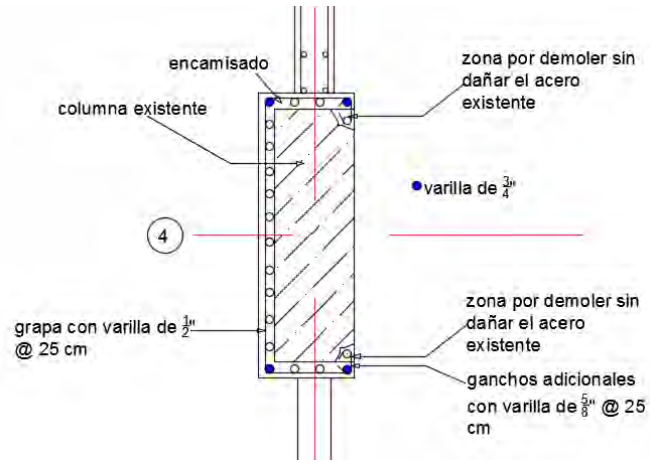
Detalle de anclaje del acero del encamisado a la columna existente eje 4
